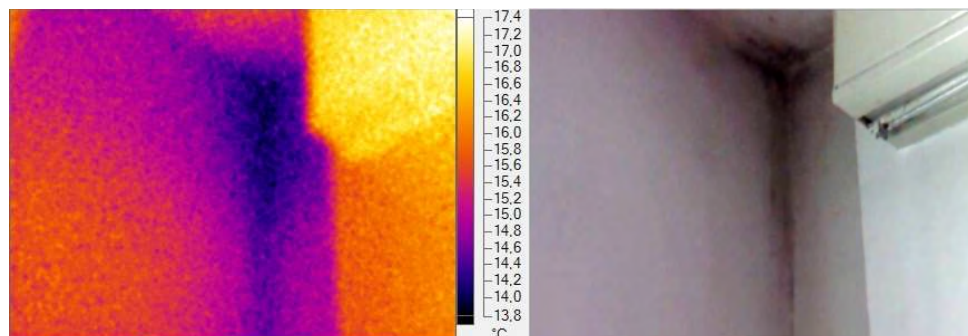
Termograma e imagen real del detalle del muro de mampostería vista en fachada suroeste. Vivienda en Montevideo.
